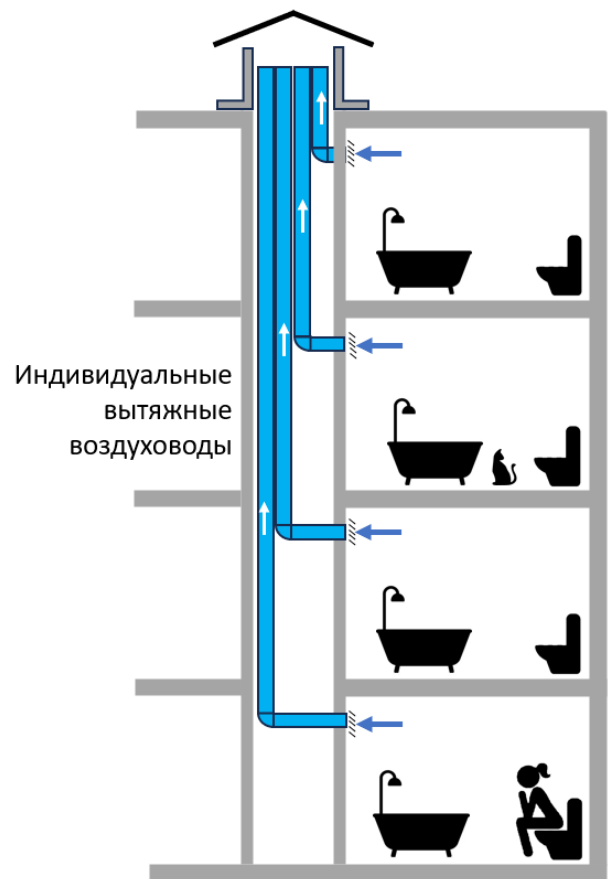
Индивидуальные стальные воздуховоды для каждого помещения
